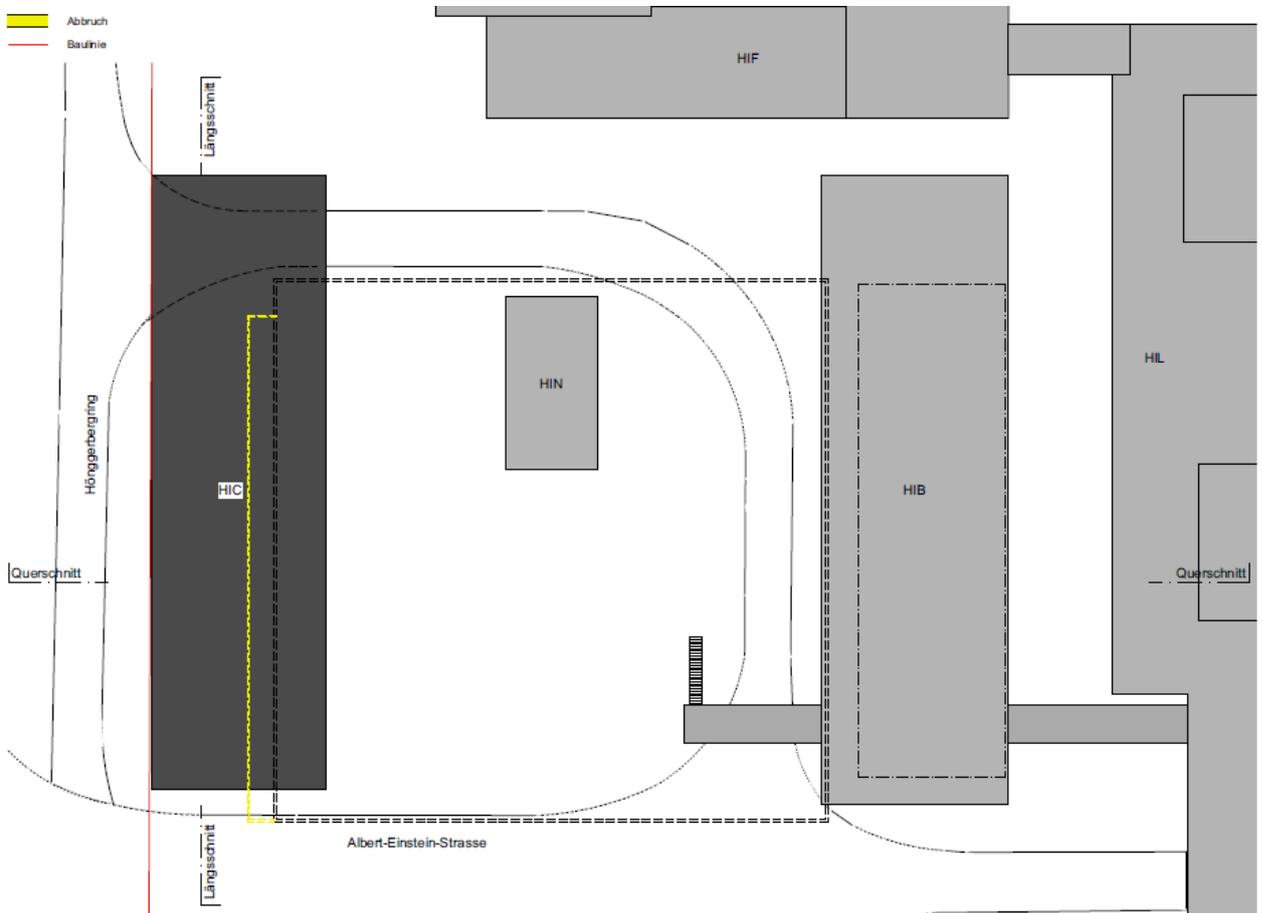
Situationsplan mit Neubau HIC/Tiefgarage und HIB
